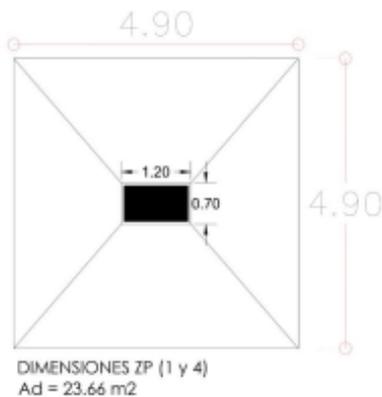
Dimensionamiento de Zapata 1 y 4 Fuente: Autoría propia
